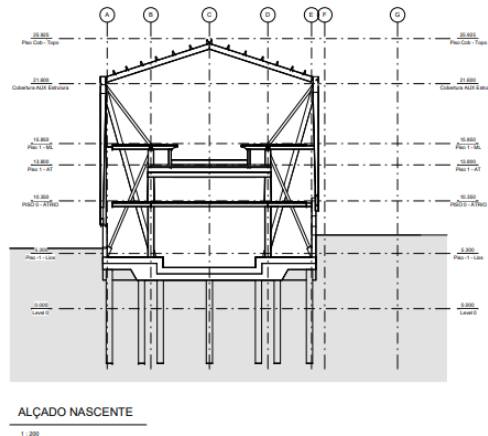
Alçado Nascente – vista frontal dos pilares de apoio em “V”
